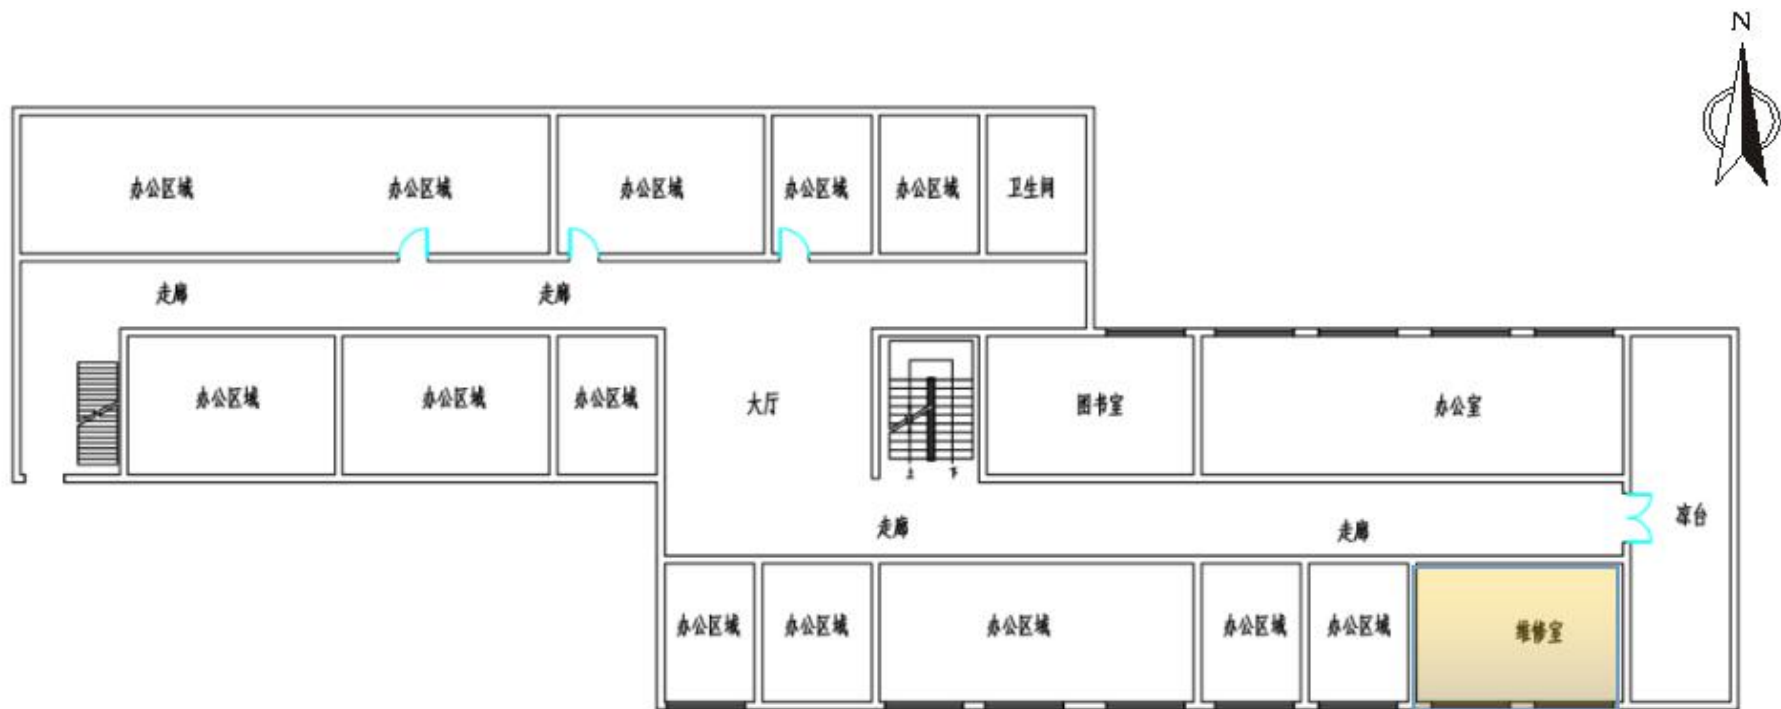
本项目 DSA 机房所在 1 号楼（三层）平面布置示意图
